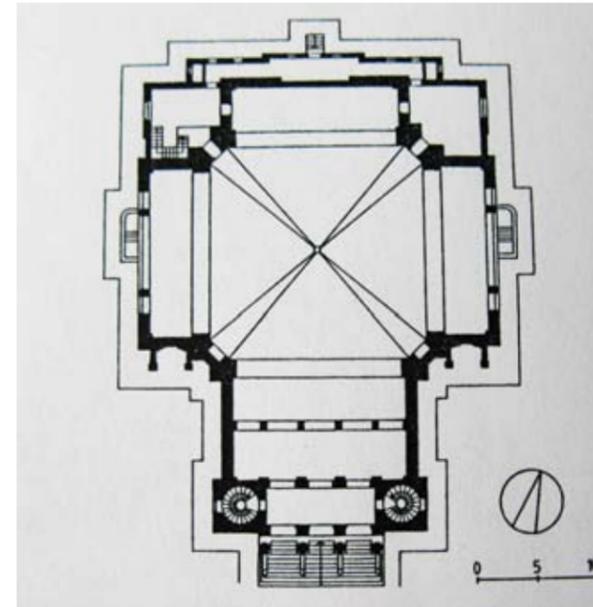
Grundriss Kirche Steinhof
